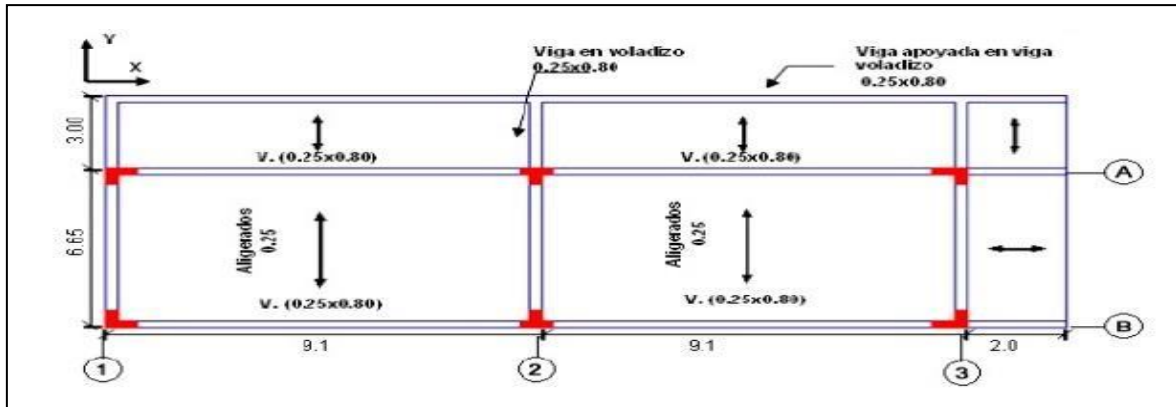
Configuración y dimensionamiento de una planta estructural típica de 3 pisos
